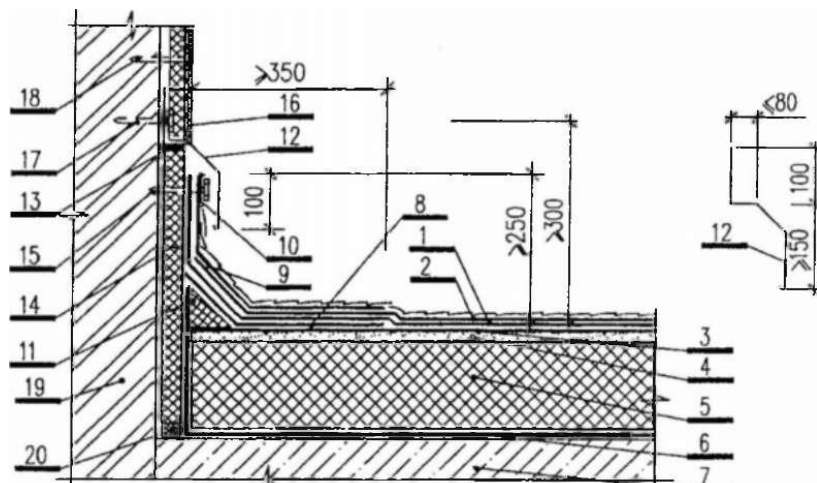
Примыканиедвухслойной кровли к стене утепленной «термошубой»
